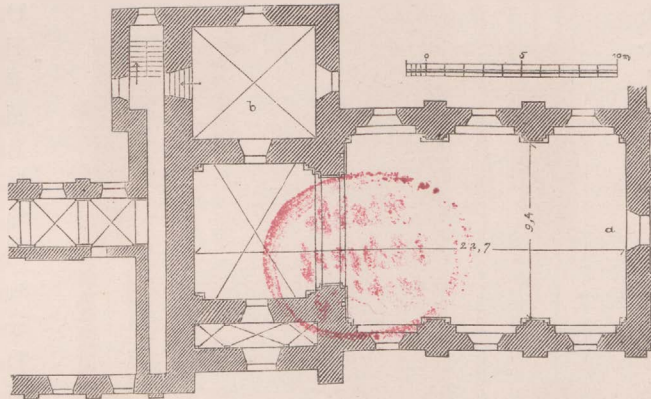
Graudenz. Grundriss der Seminarkirche.
